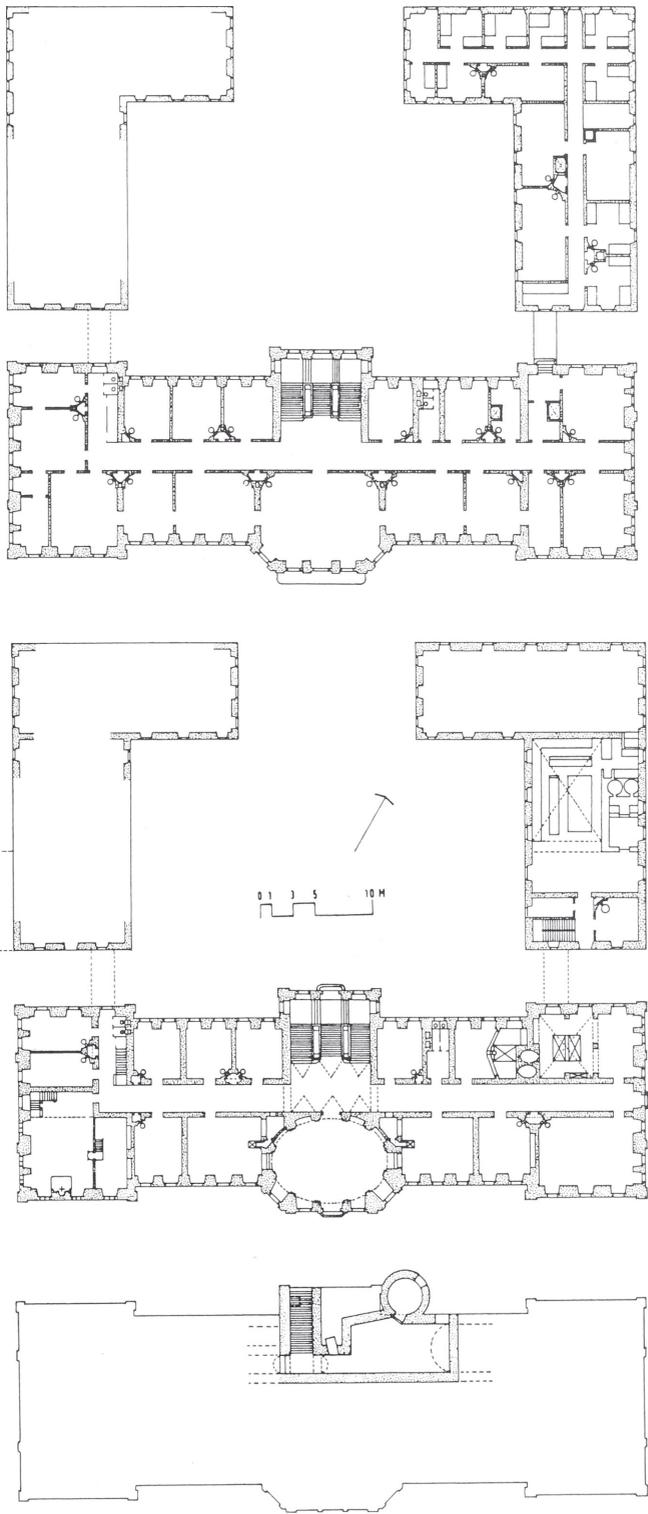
Schönbornlust (Zeichnung: Verf., 1996). Grundrisse, oben: Obergeschoss, unten: Erdgeschoss (nach B. Neumann [Delin II/165 u. 166] u. J. C. Rolshausen, 1781).
